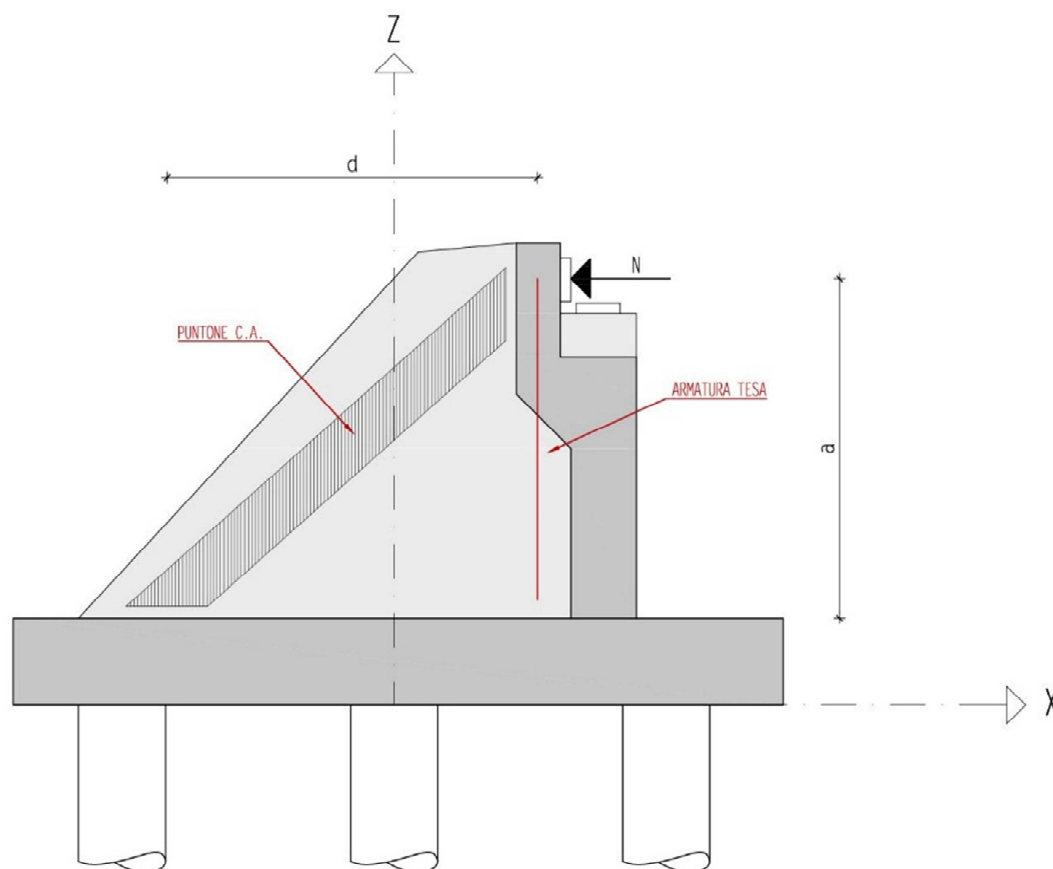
Schema puntone tirante per la spalla
